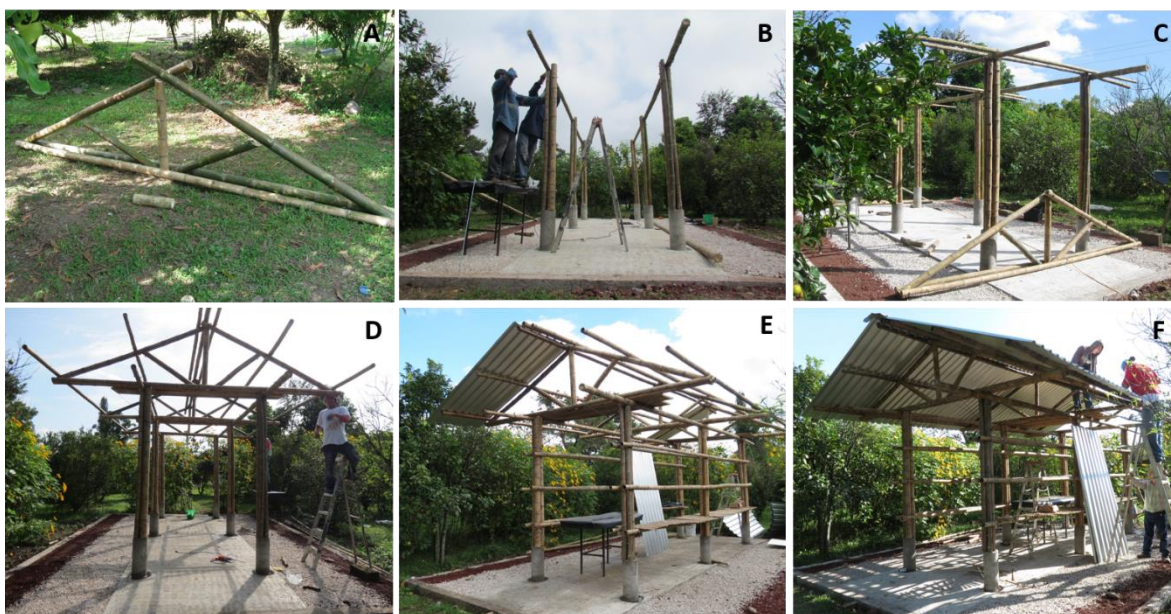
A: Viga tipo Pratt. B: Ensamble de columnas. C: Ensamble de vigas. D: Ensamble de vigas tipo Pratt. D y E: Ensamble de lámina acanalada. Foto: H. R. Salazar-Vargas.
